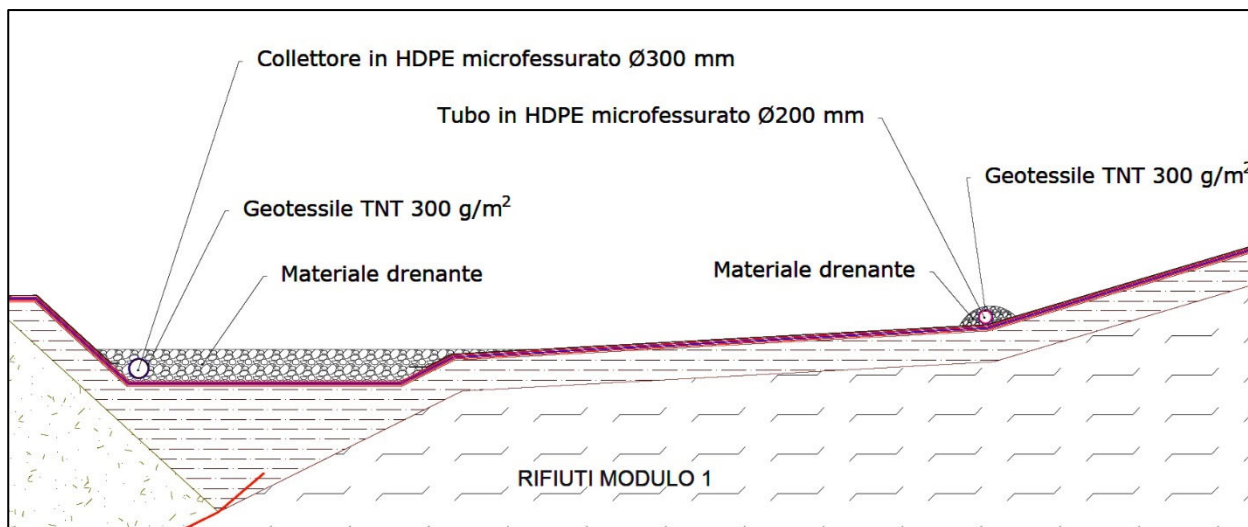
/XIV: Particolari costruttivi rete di drenaggio
